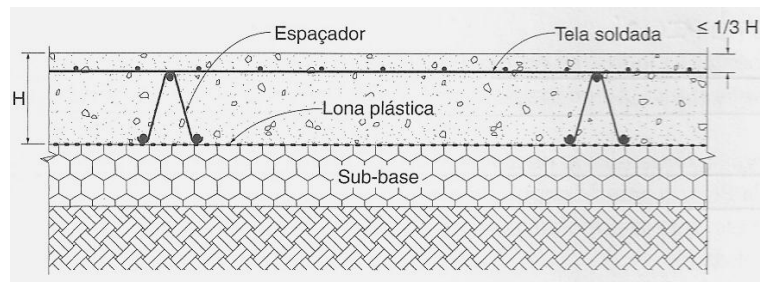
Seção tipo: Pavimento de concreto simples com armadura distribuída (Rodrigues et al., 2006)
